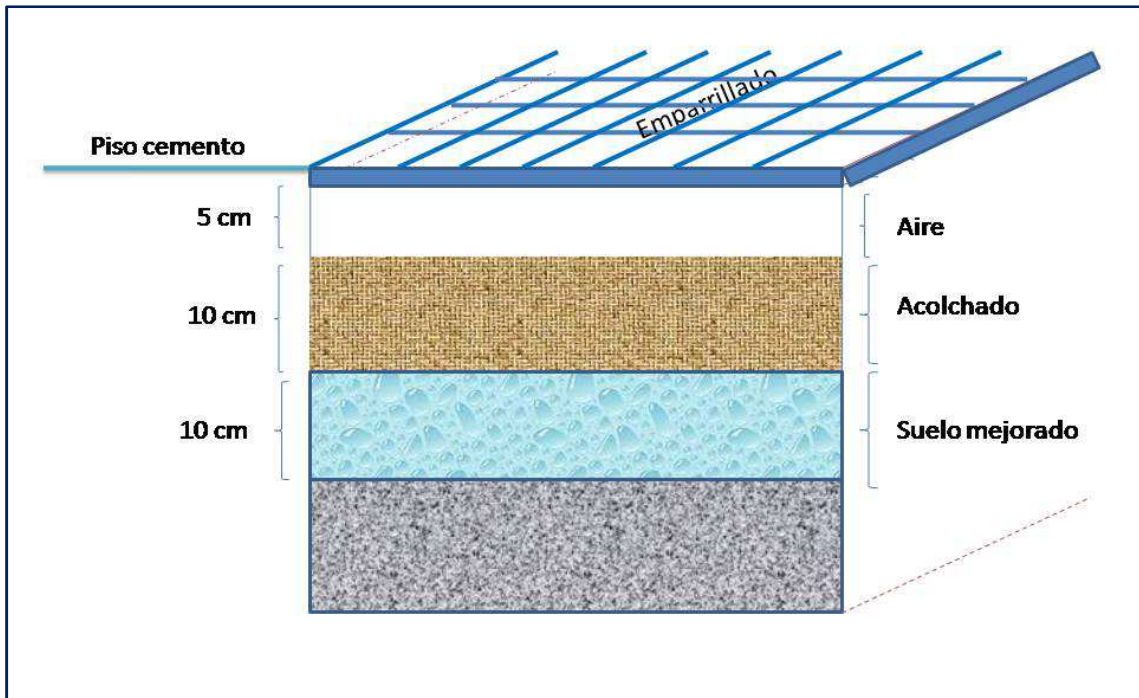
Vista de perfil del sistema de aireación y drenaje.
